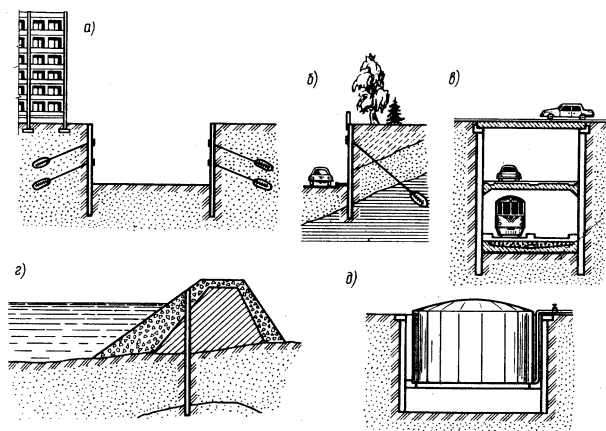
Конструкции, сооружаемые способом «стена в грунте»: а – котлованы в городских условиях; б – подпорные стенки; в – тоннели; г – противодиффузионные диафрагмы; д – подземные резервуары [2]
